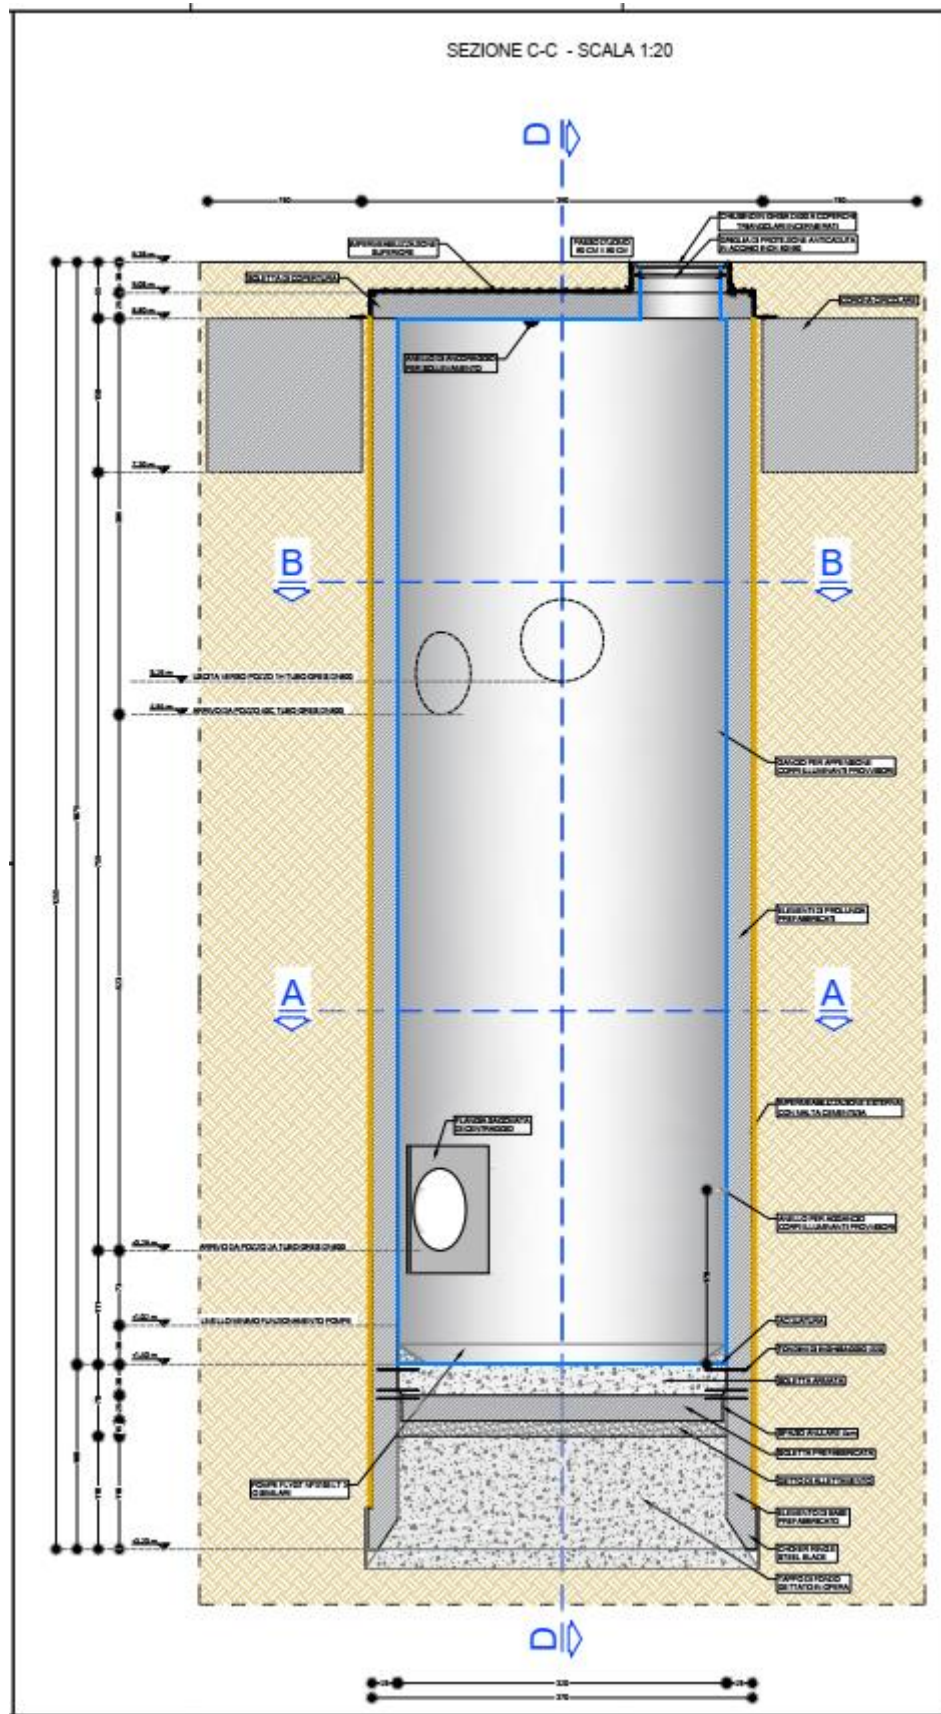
G : Schema dimensionale geometrico pozzo autoaffondante
